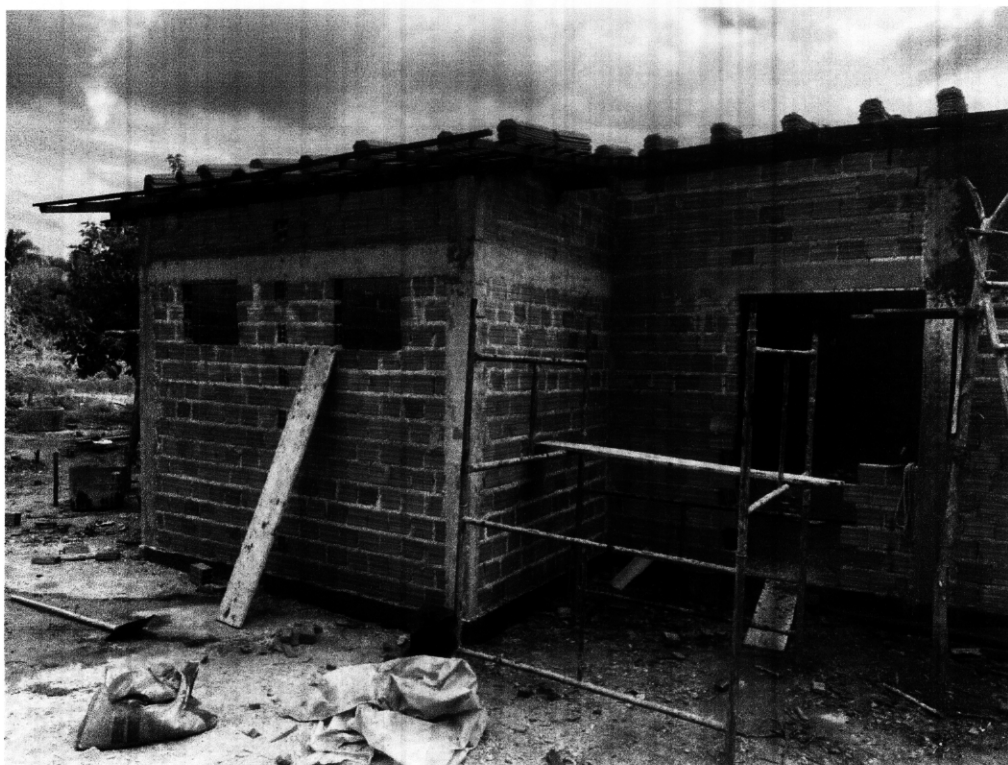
inclusão de pilares e viga Baldrame e superior, trama de madeira, alvenaria e fundação.
